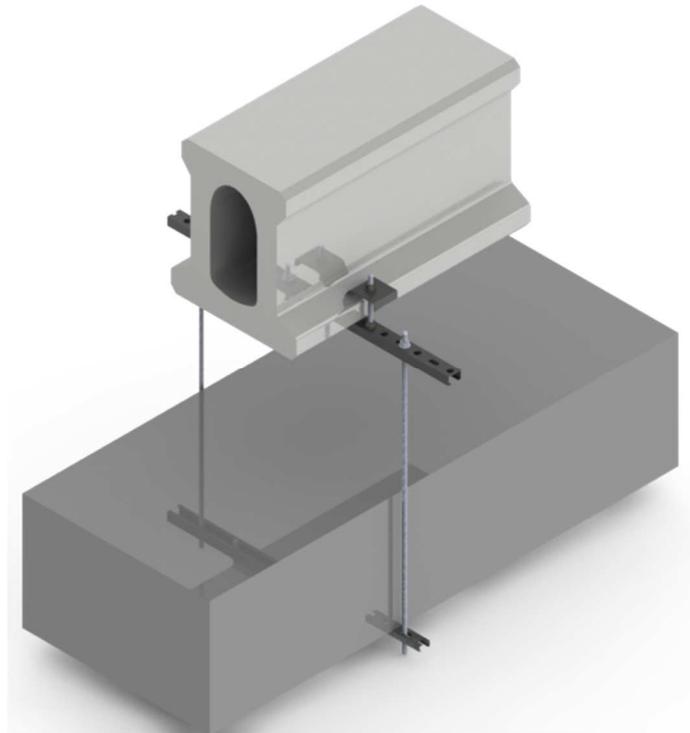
Conducto de aire acondicionado paralelo a perfil instalado en sistema propuesto.
